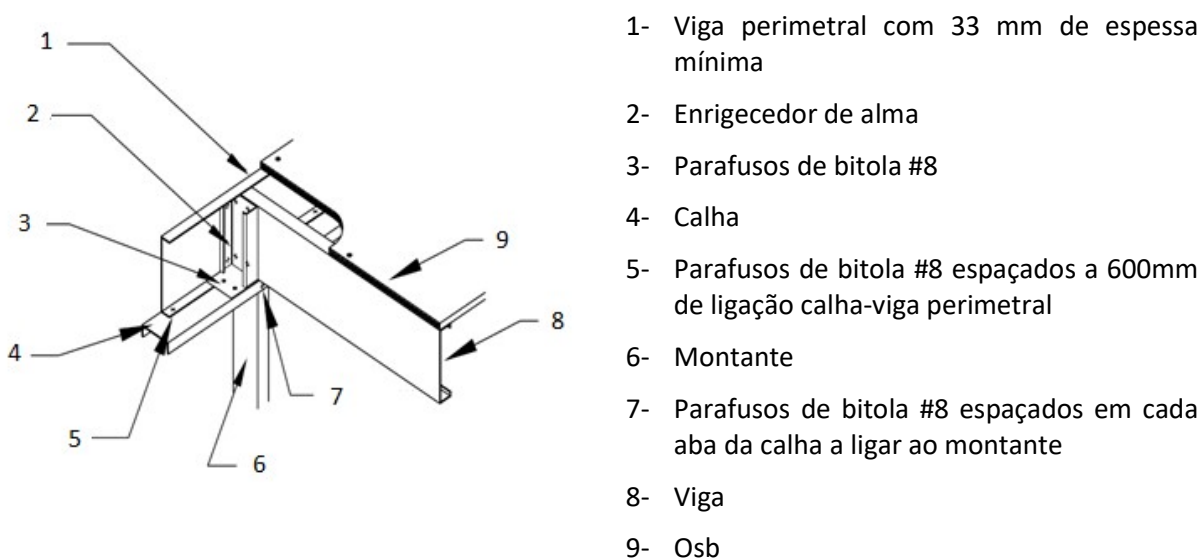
Ligação pavimento de LSF a uma outra estrutura em aço leve (Anónimos, 1997)
